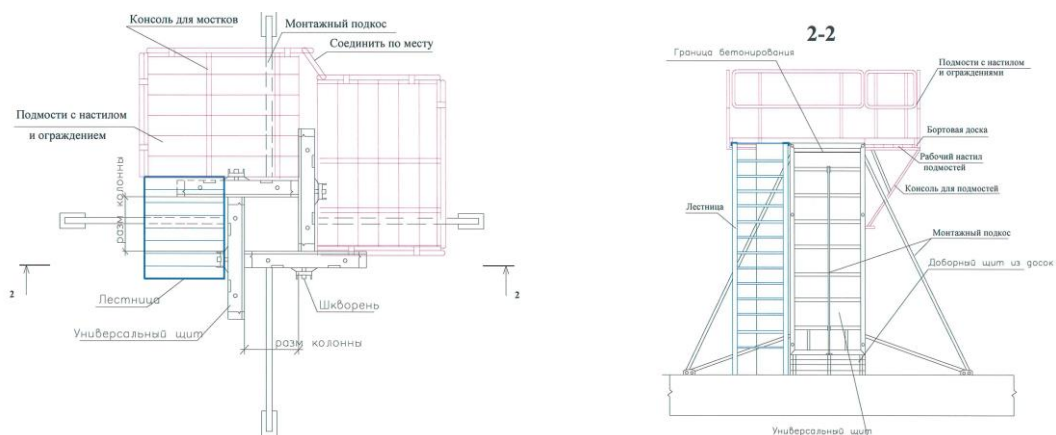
Схема опалубки для бетонирования пилонов (колонн)
